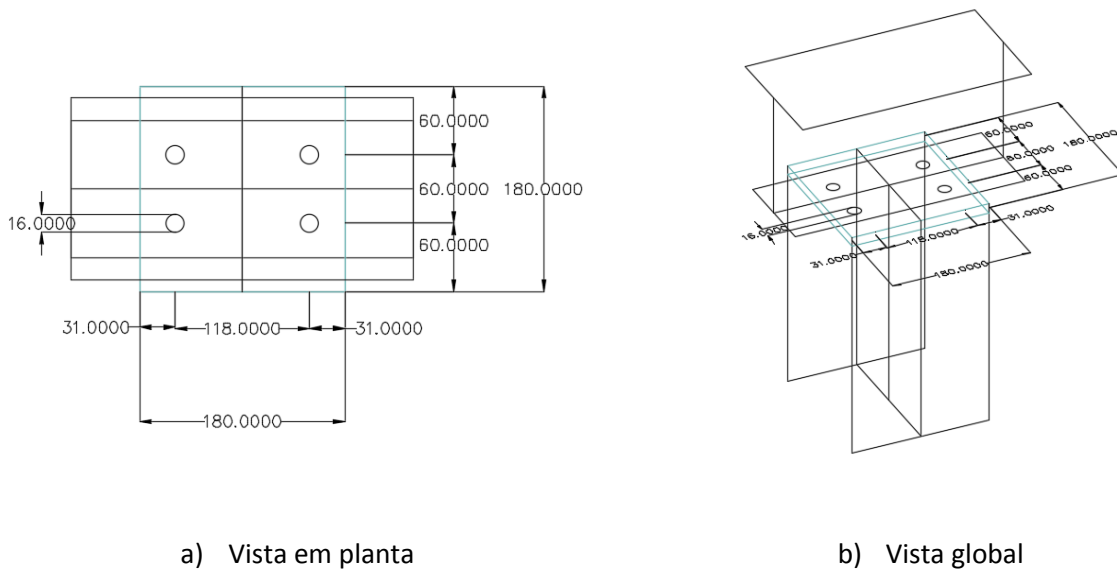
Pormenor construtivo da ligação dos pilares da fundação C com as cordas inferiores da treliça
